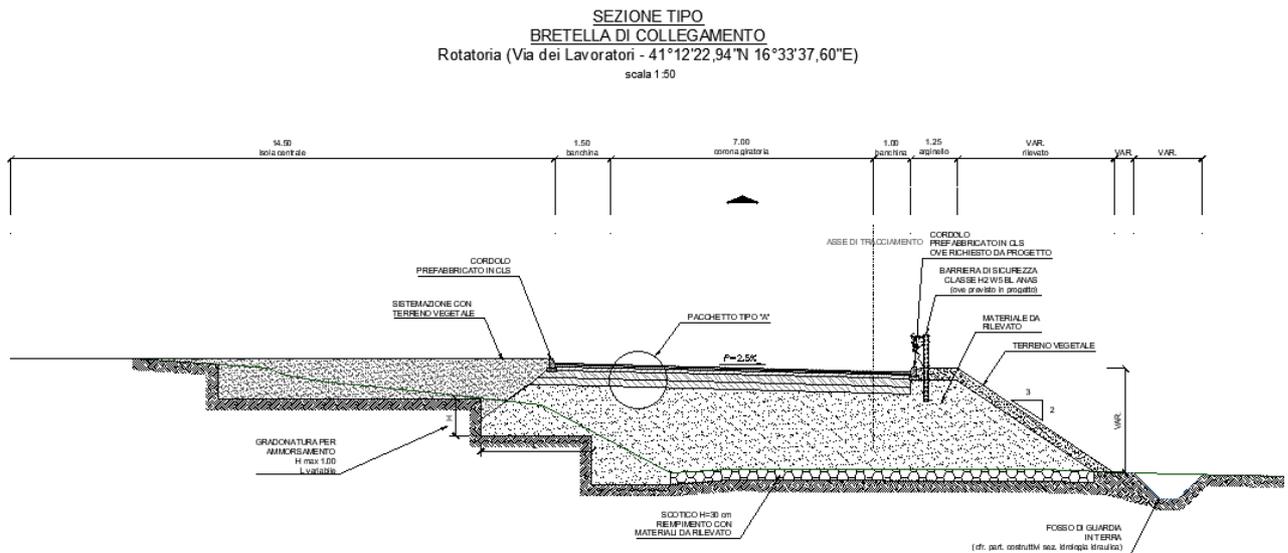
Sezione tipo rotatoria Via dei Lavoratori
